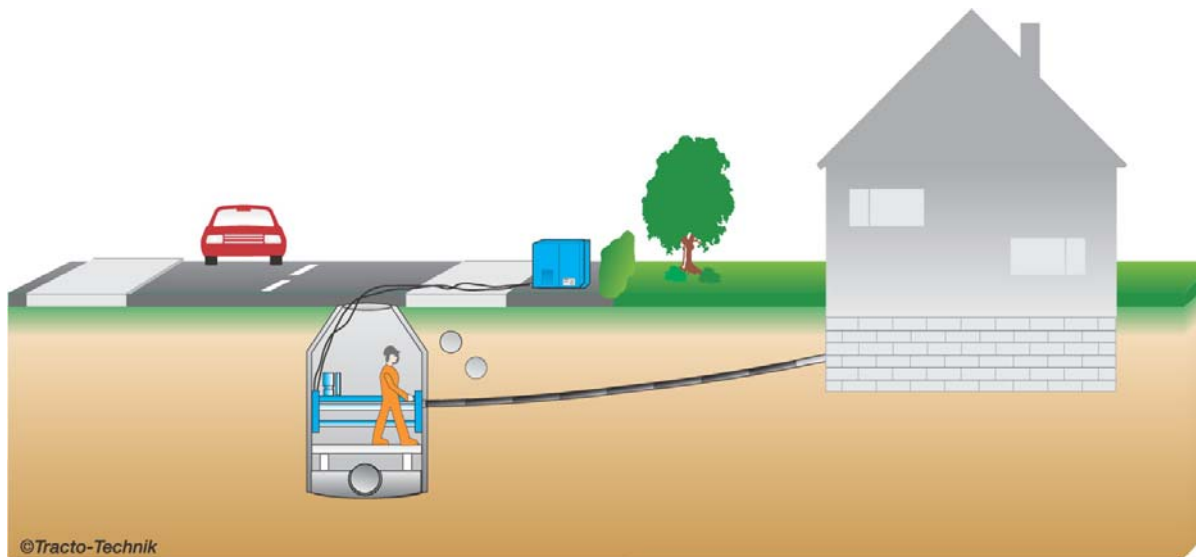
Grabenloser Hausanschluss mit dem GrundoSchachtbohrsystem
